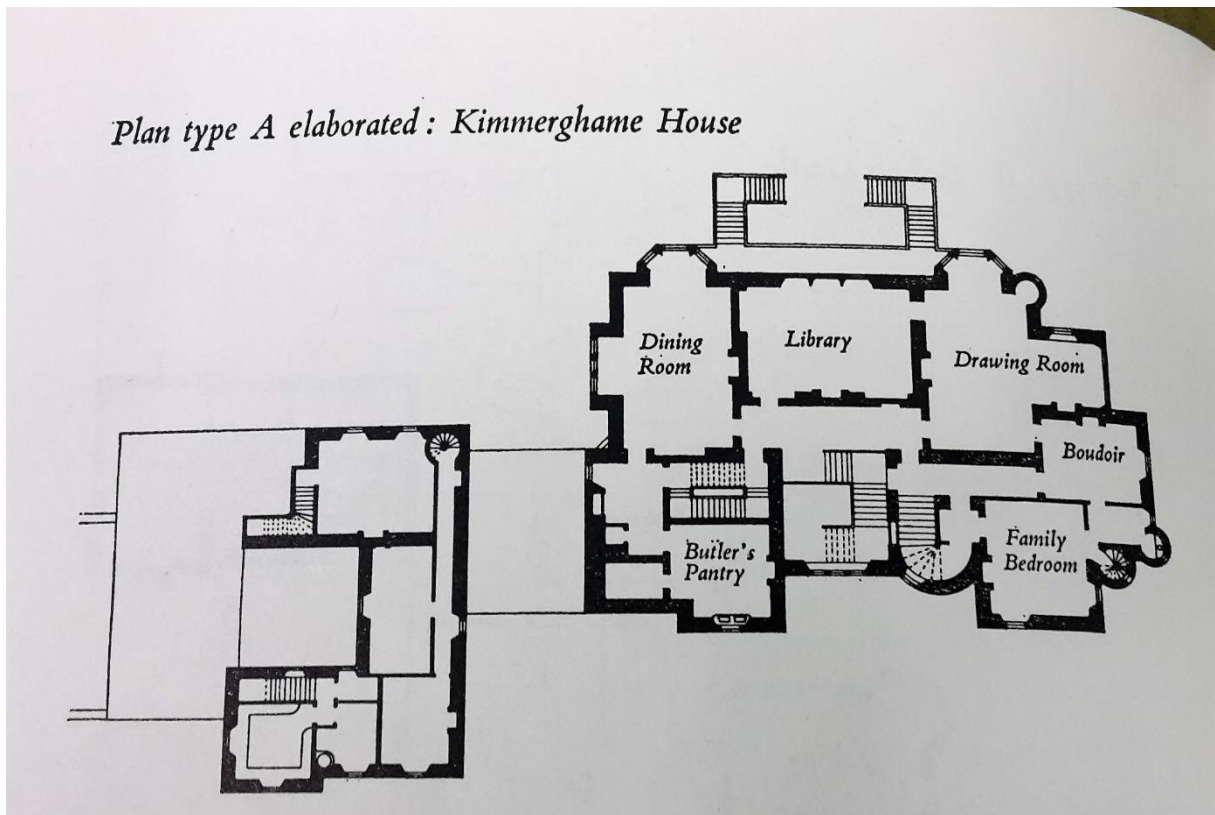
Plan de type A amélioré par certaines modifications réalisées par Bryce pour Kimmerghame House.
